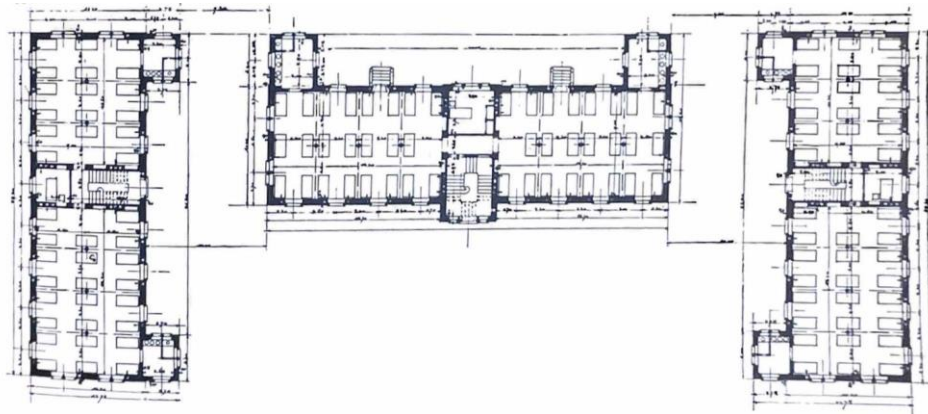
Planimetria generale del complesso convittuale. Rilievo di progetto (A. Abriani, *Patrimonio edilizio esistente. Un passato e un futuro*, p. 779)
